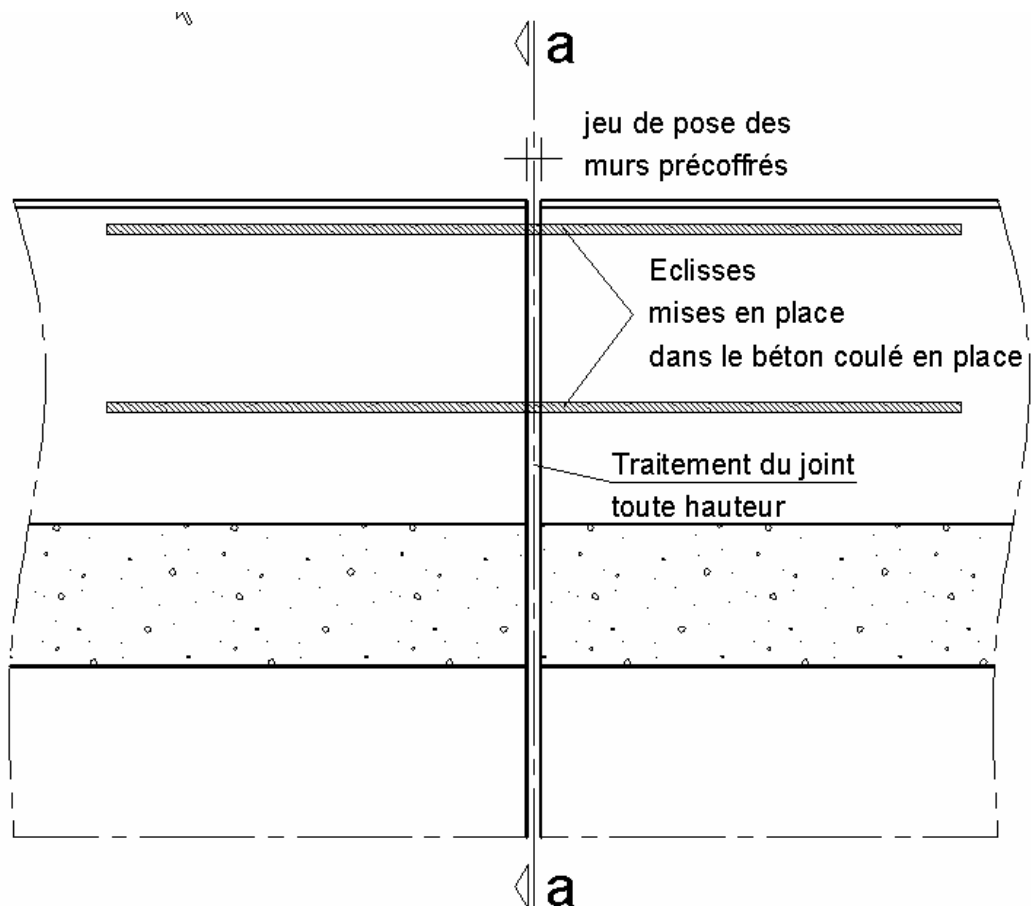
DETAIL AUX JOINTS DESACROTERES BAS
